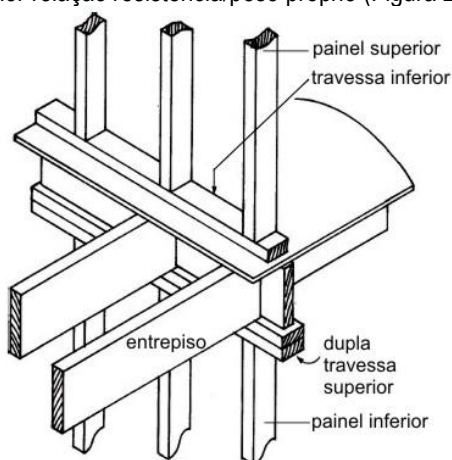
Estrutura de entrepiso, apoiada sobre os painéis do pavimento inferior. Fonte: adaptação AF&PA, 2001.
